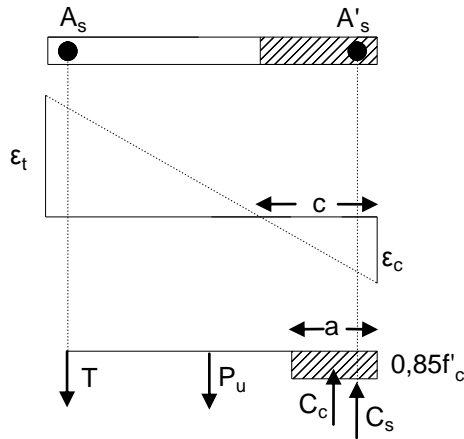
Sección de concreto reforzada al alcanzar la máxima capacidad.
